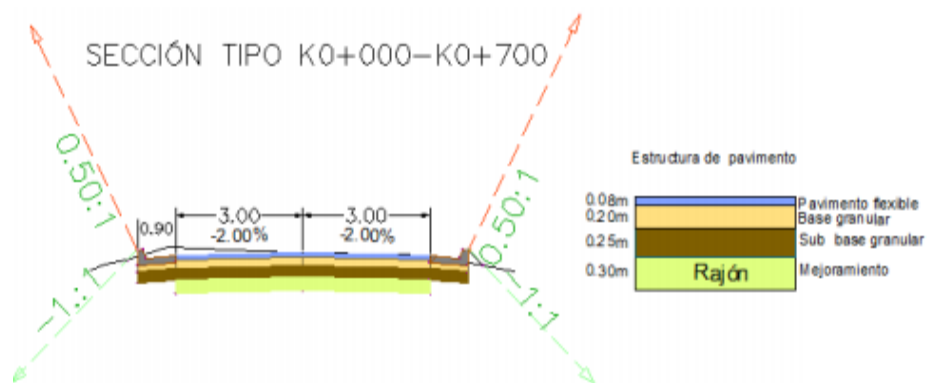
Sección transversal típica k0+000-k0+700, corredor vial Túnel- Las cruces
